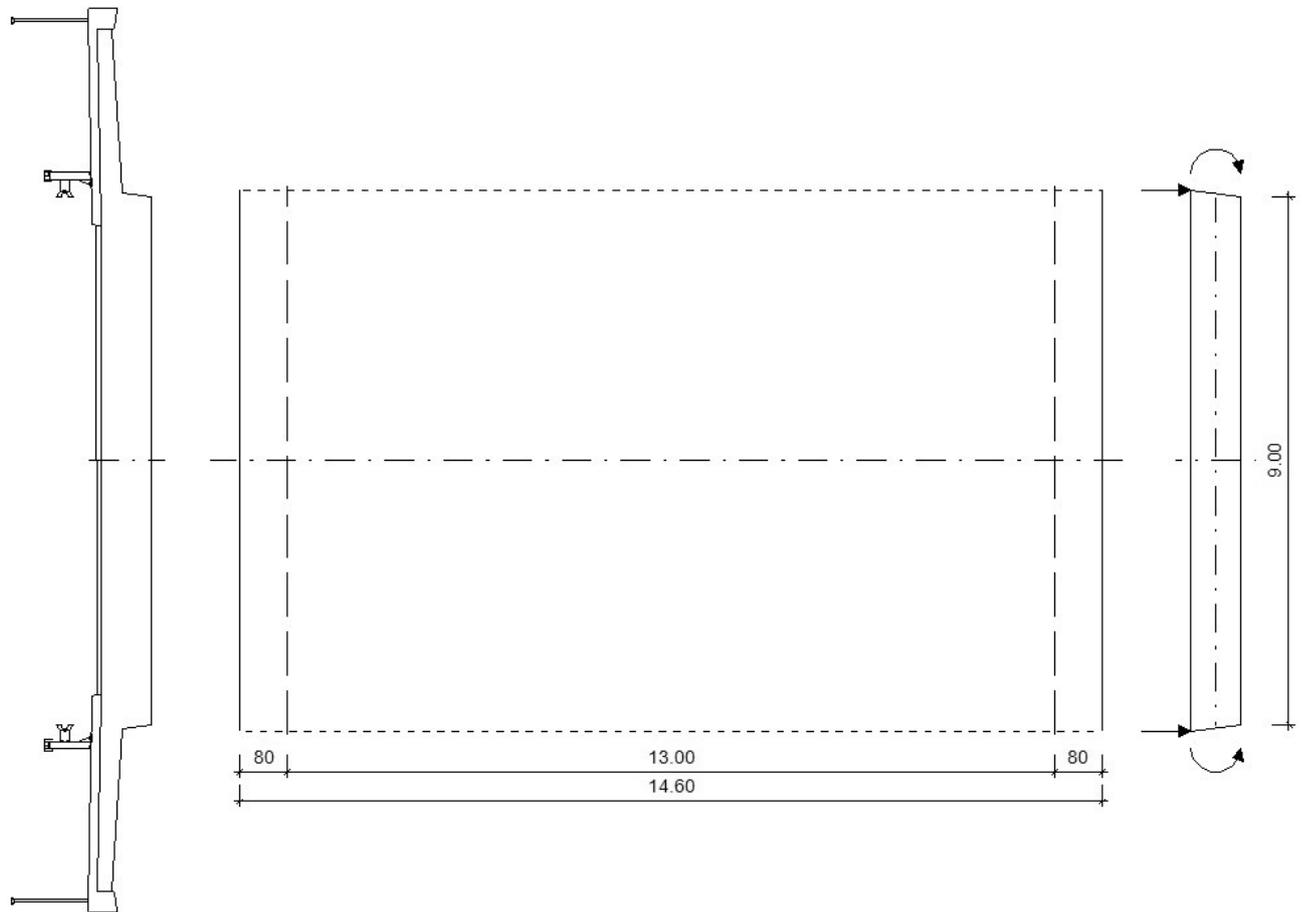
Grundriss des Tragwerkes
